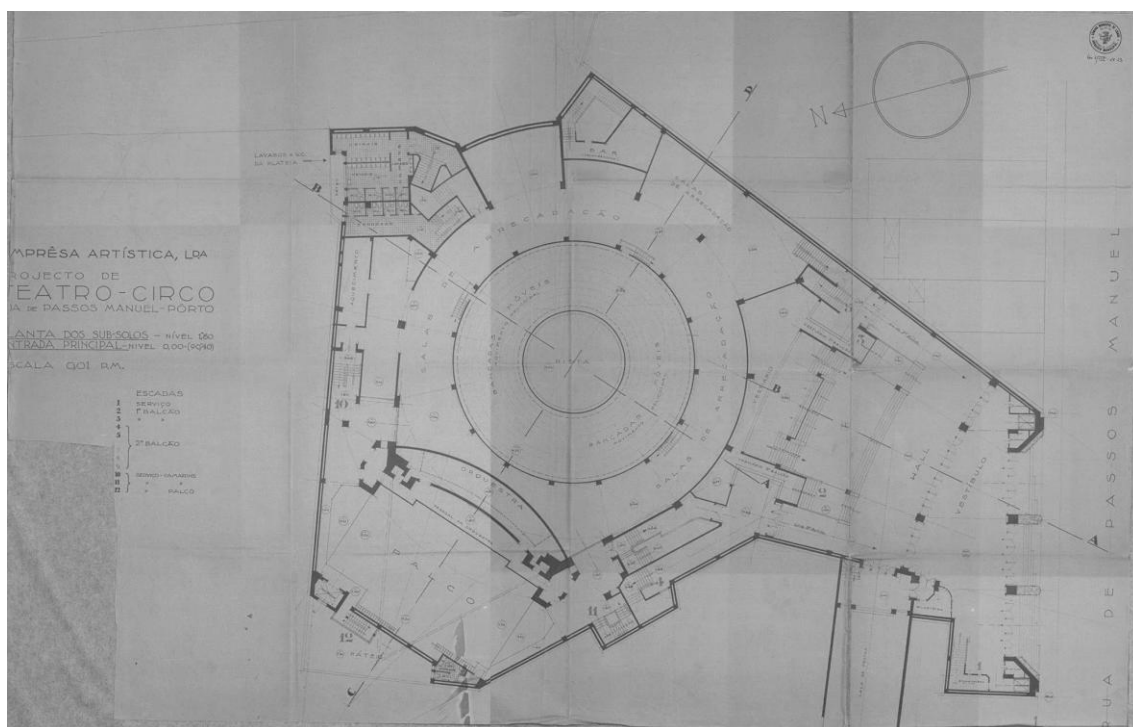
Planta dos subsolos e da entrada principal, Cassiano Branco, 1938
